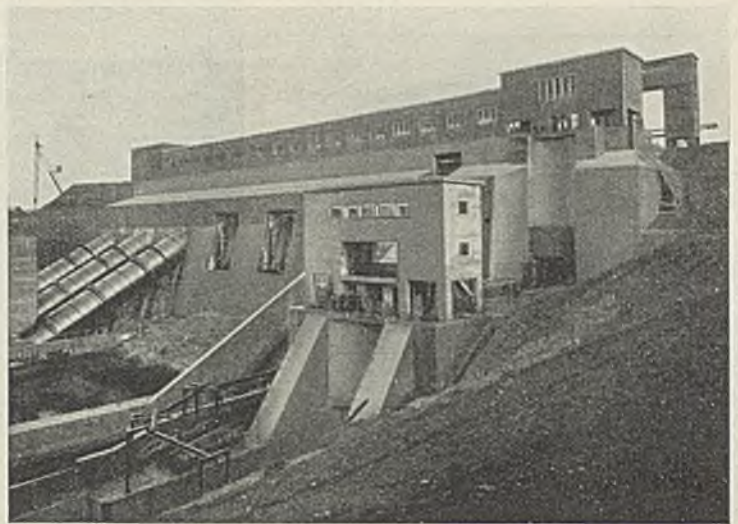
Schleuse mit Wasserschloß und Druckrohrleitung.
